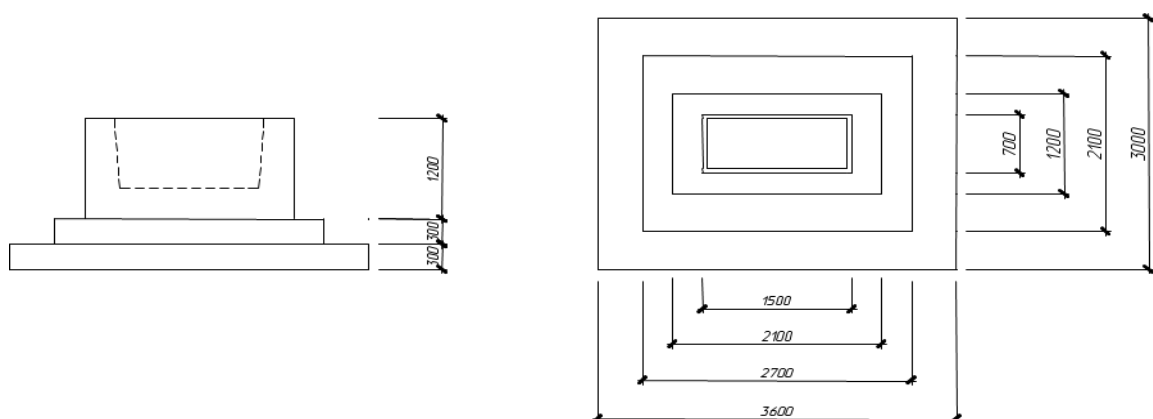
Фундамент колон типу ФД-11-6
